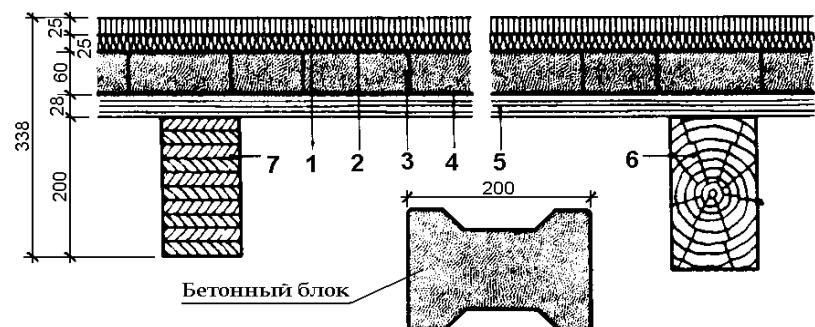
Деревянные балочные перекрытия. Вариант I.
